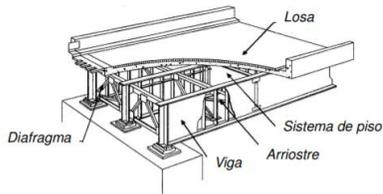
Sistema de viga I. Fuente: MOPT, (2007)
